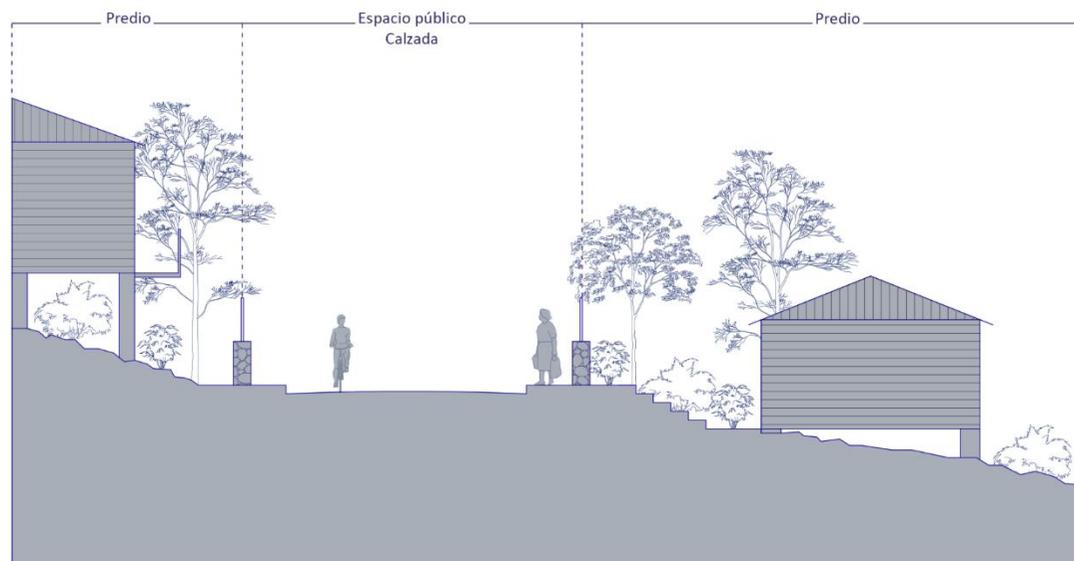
Perfil de calle zona interior vaticano y caleta, acompañado de imágenes especificando tipo de inmuebles y zona, 2023, Elaboración propia CMN.
